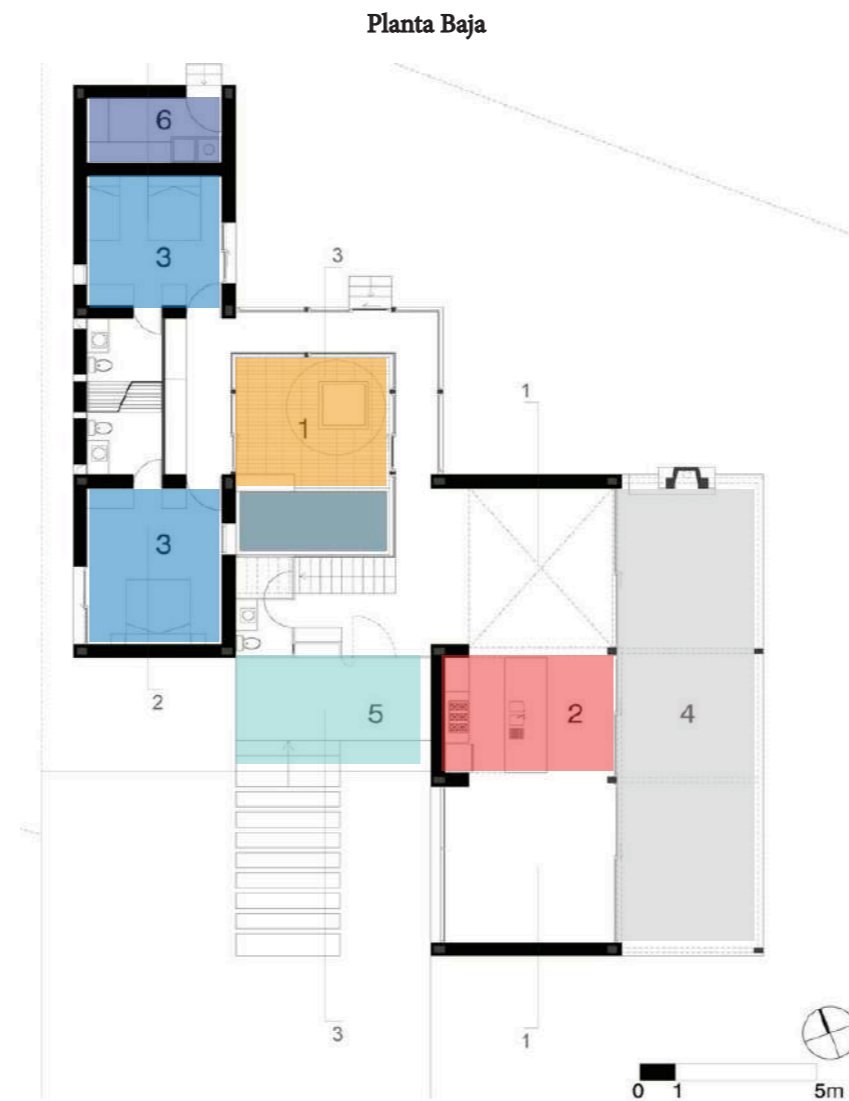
Casa en Cotacachi- análisis espacial planta baja
